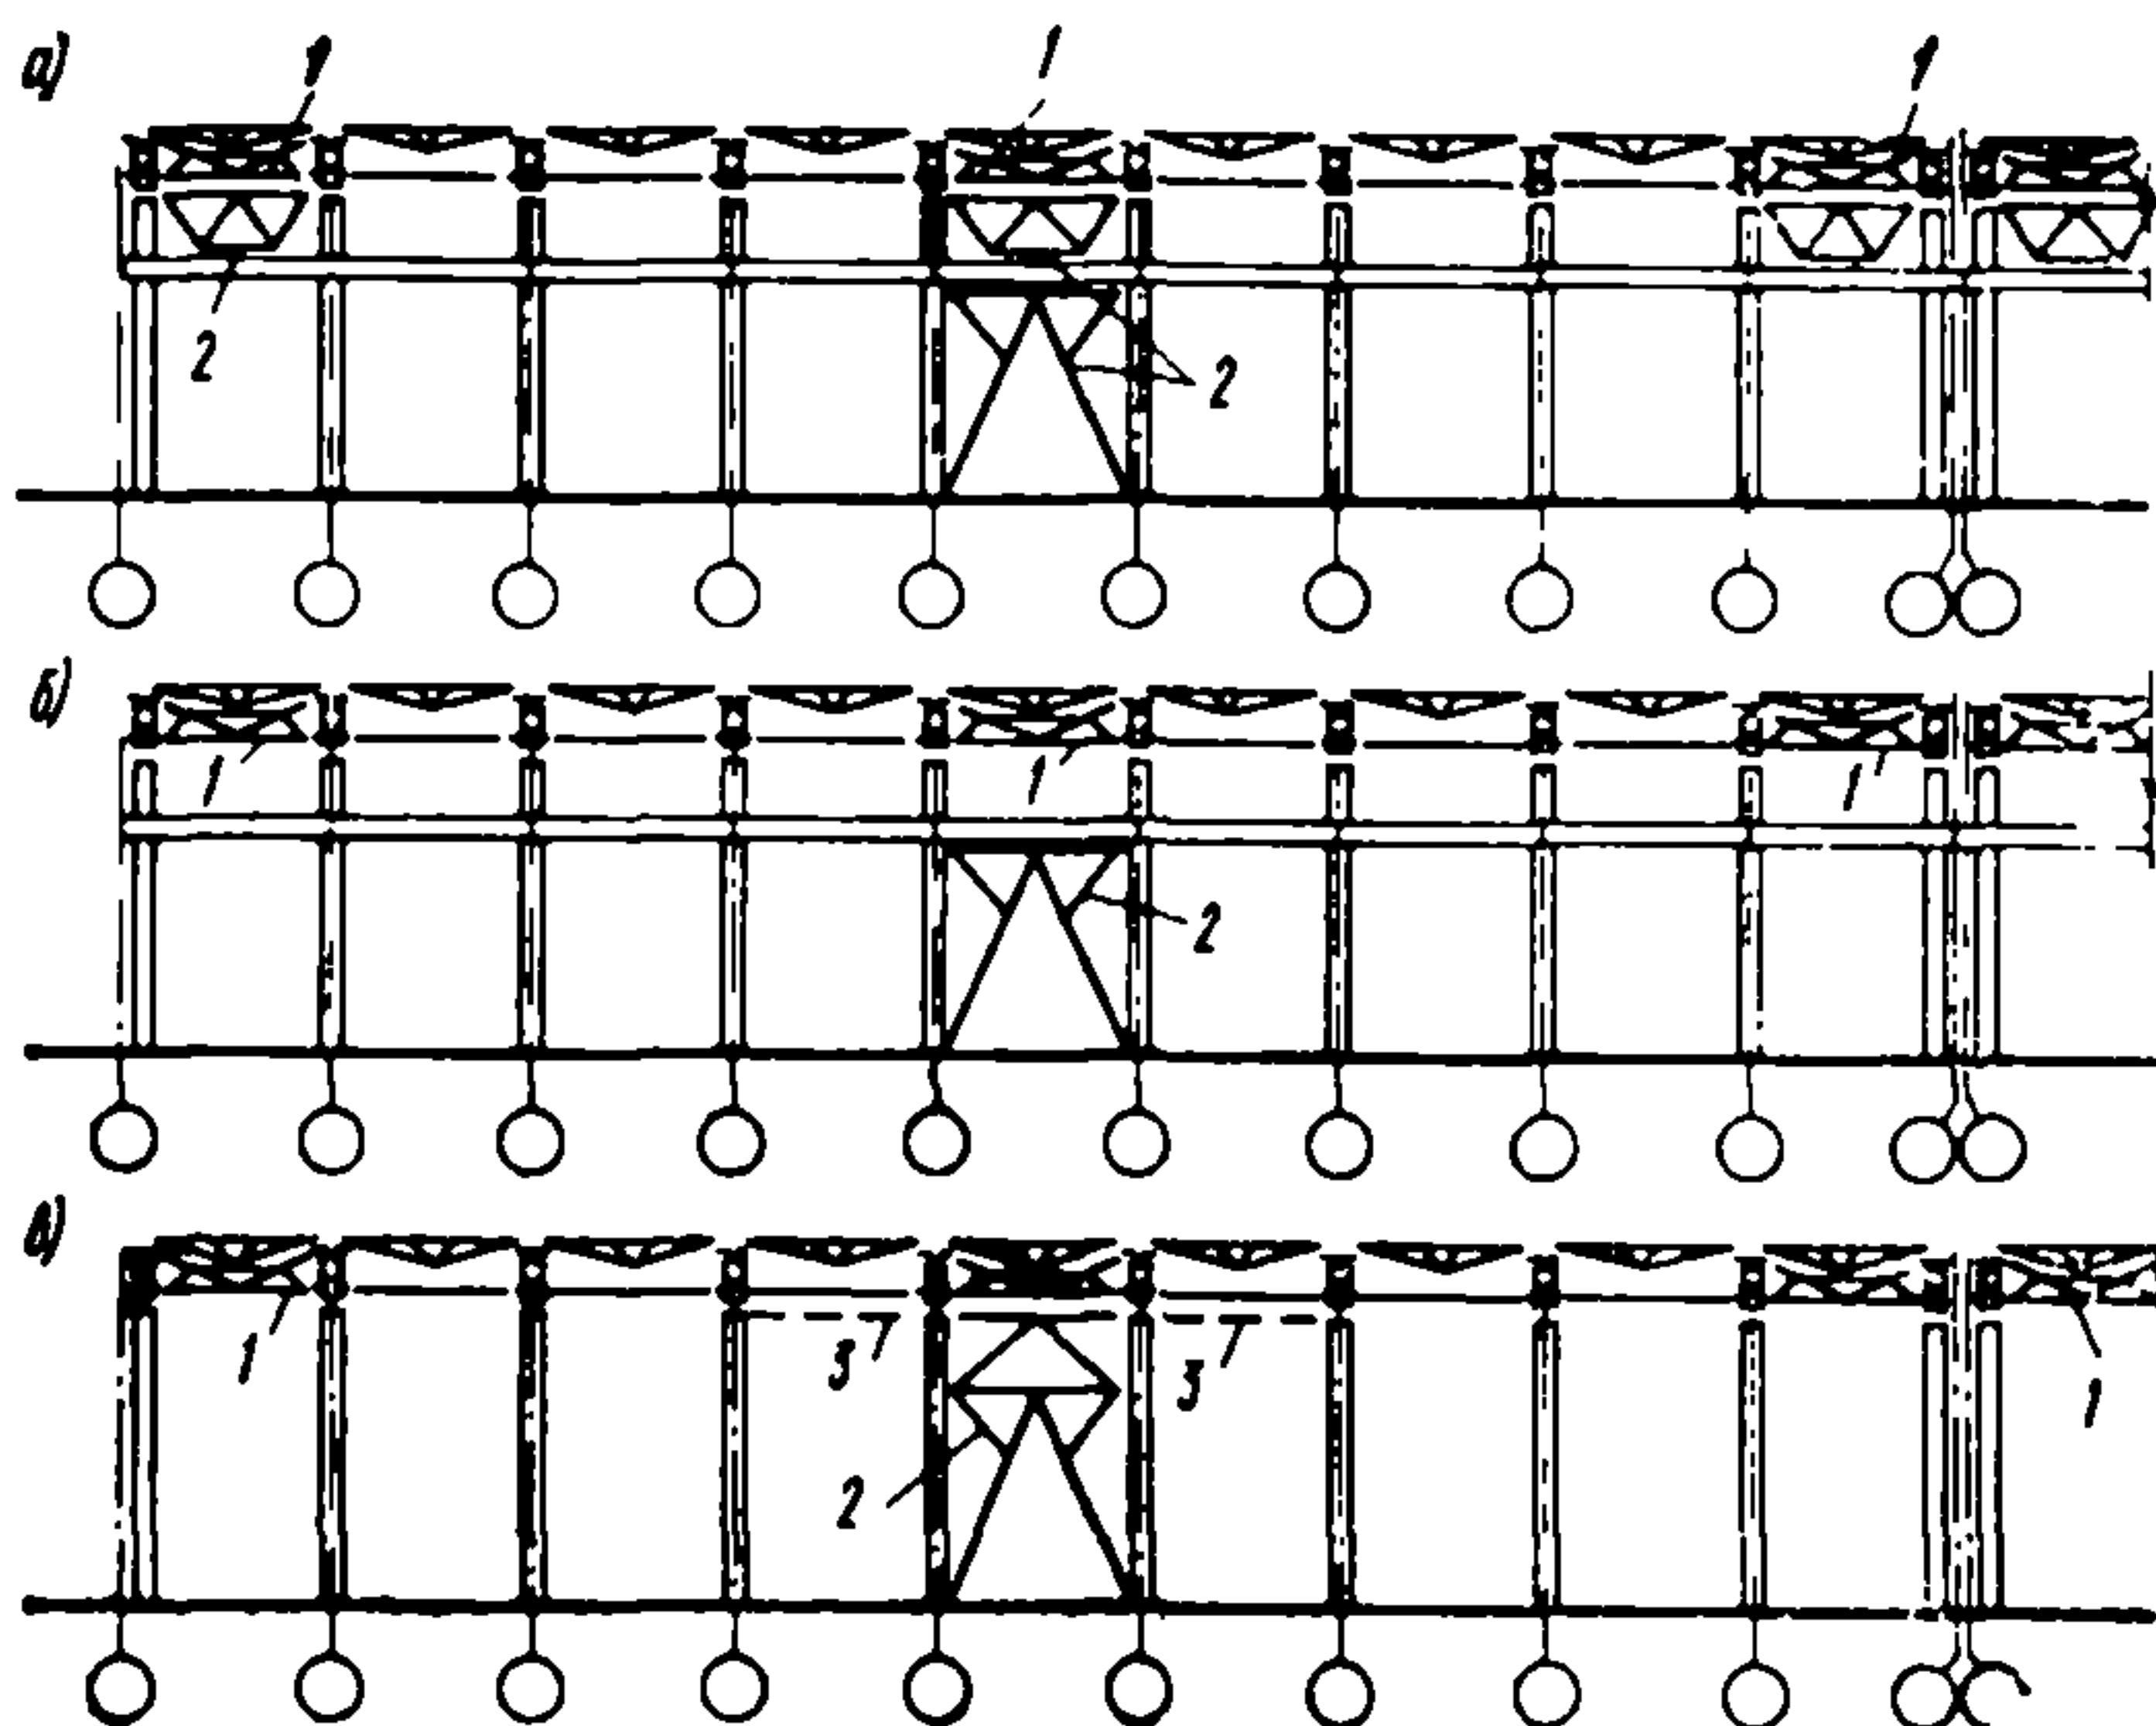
Примеры схем расположения вертикальных связей между колоннами в зданиях с мостовыми кранами при стальных (а) и железобетонных (б) колоннах и в зданиях без мостовых кранов (в)
